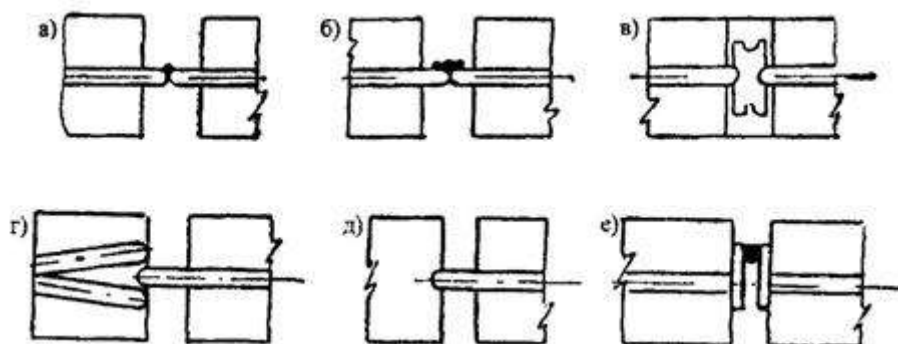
Стыковые соединения для предварительно напряженных плит:
